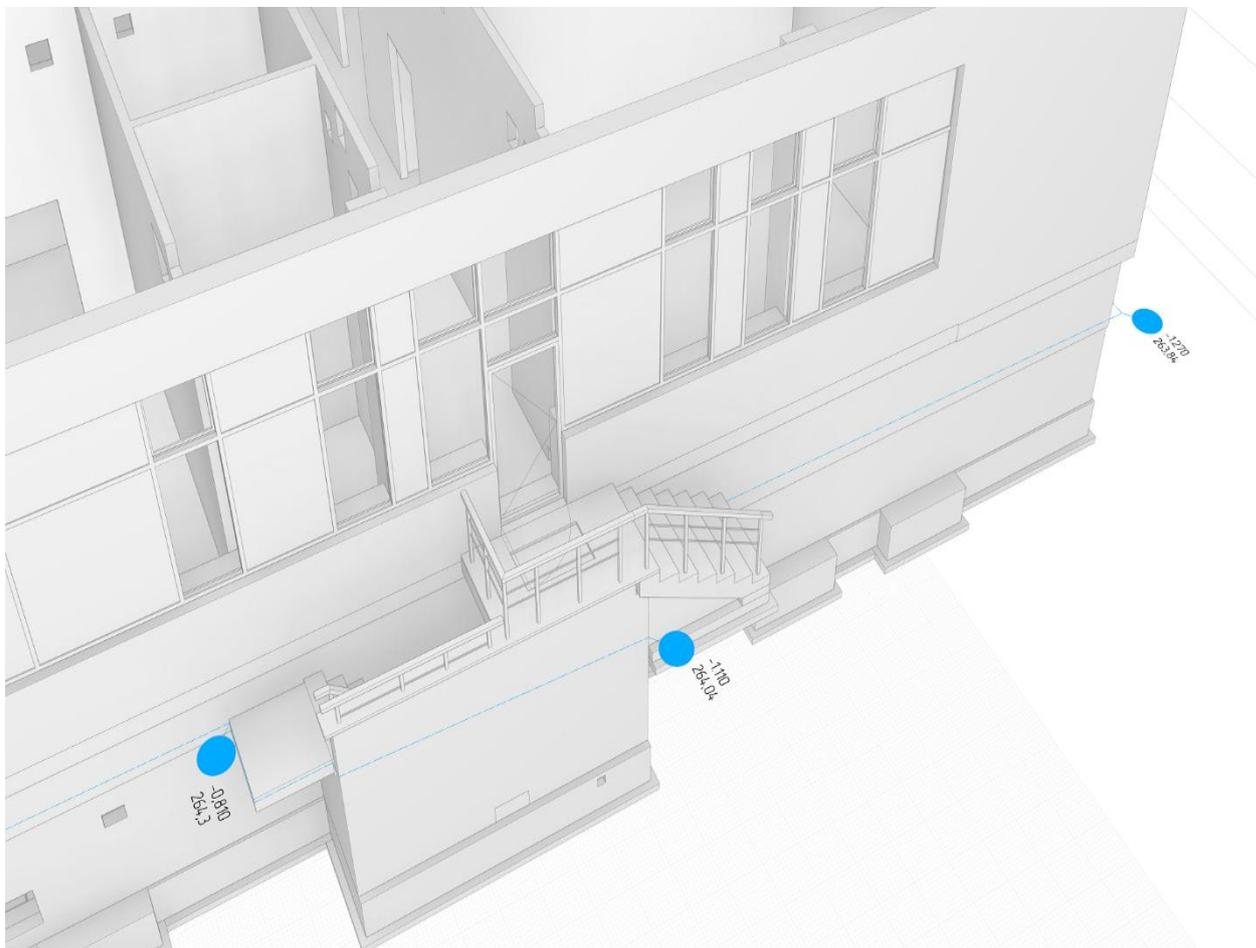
Архитектурно-строительная модель, дополненная окнами, дверьми, фасадом.
